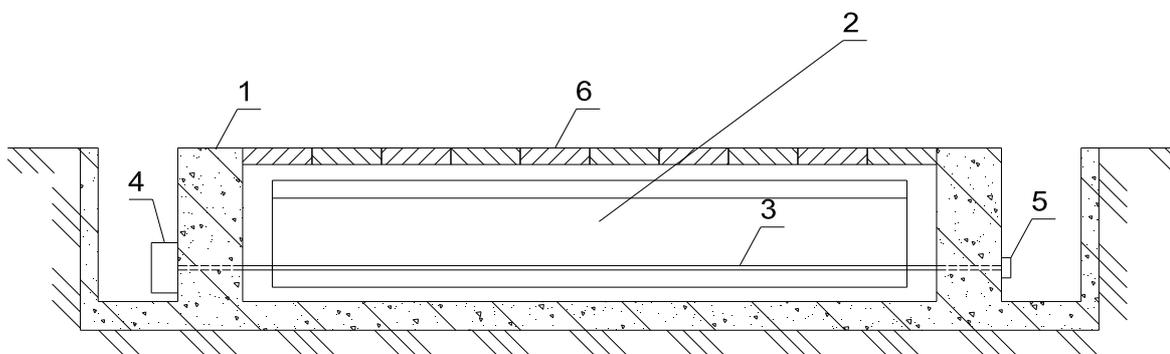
Схема стандового изготовления цельнопролетной предварительно напряженной балки: 1 - силовой железобетонный стенд заглубленного типа; 2 - изготавливаемая балка; 3 - напрягаемая арматура из канатов К-7; 4 - домкрат двойного действия; 5 - глухой анкер; 6 - крышка из железобетонных плит
